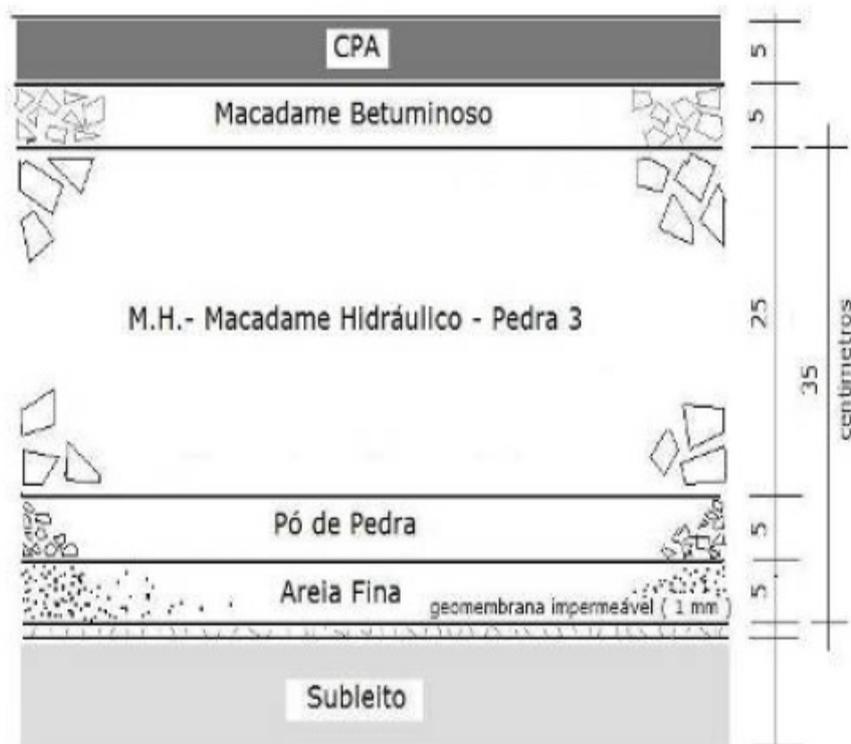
Perfil de pavimentação para uso com concreto asfáltico poroso e geomembrana impermeável. Fonte: Virgiliis, (2009).
